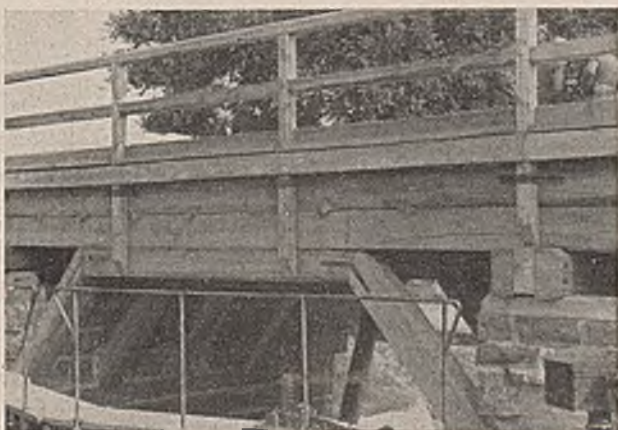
Trapezsprengwerk mit verdübelten Balken über einem Schleusentor.
